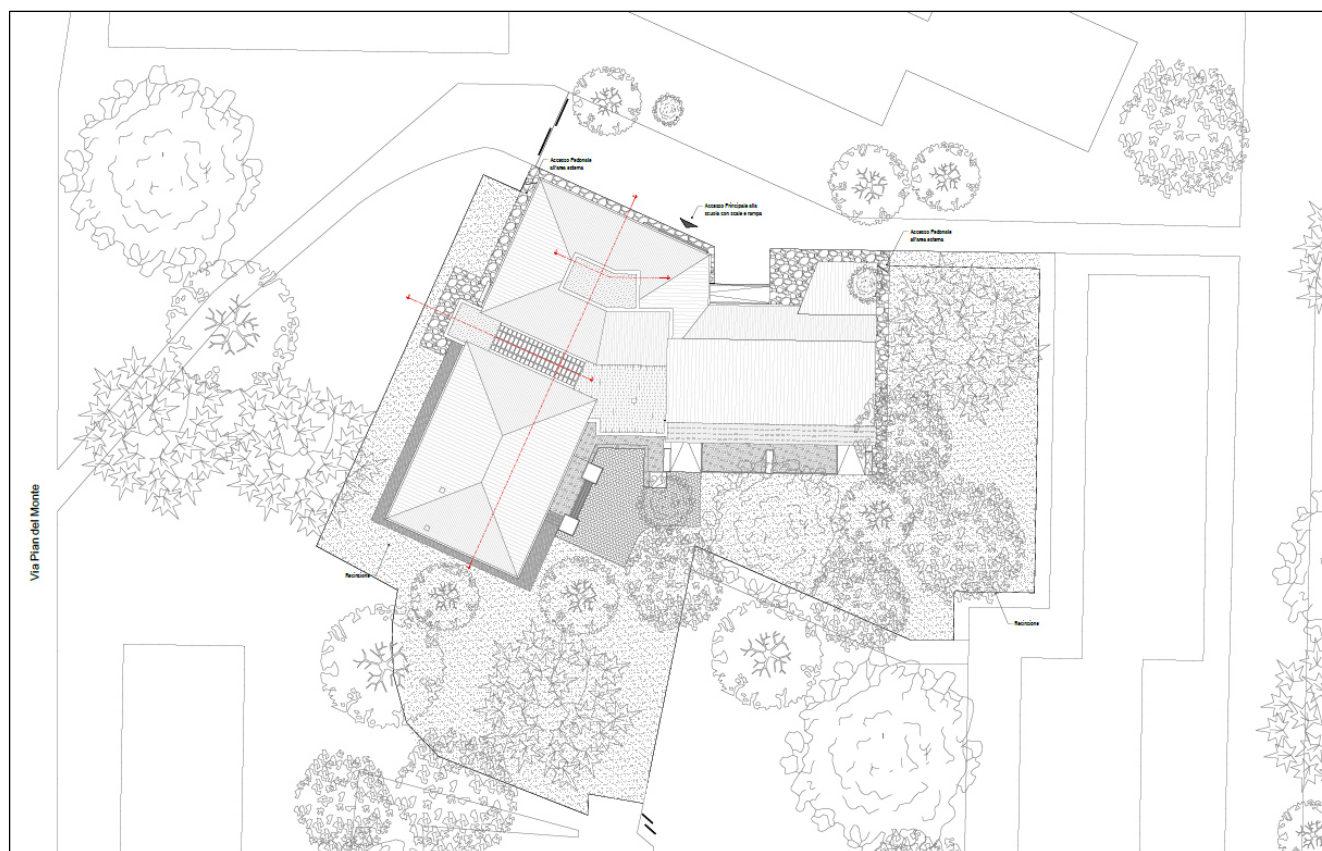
Planimetria dello stato di fatto con individuazione dell'area di pertinenza
